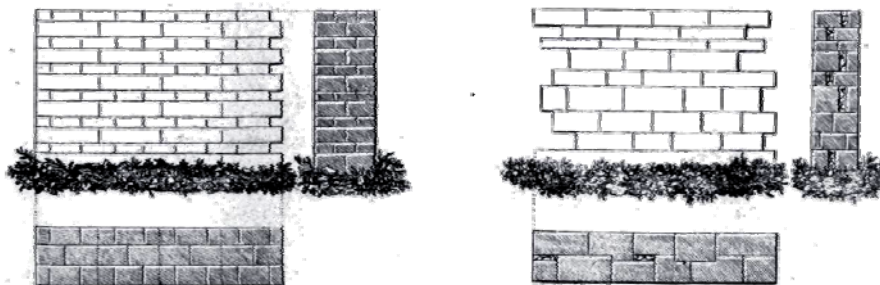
Muri realizzati in pietre concie con struttura *irregolare* (Cavalieri, 1839)
